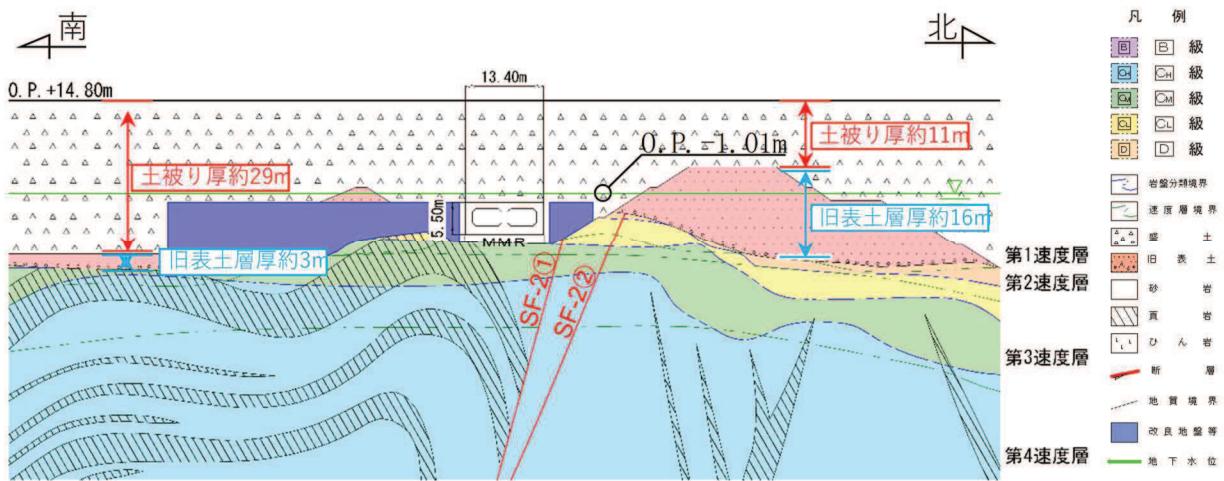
取水路（標準部） 地質断面図（断面⑥：曲線部）
